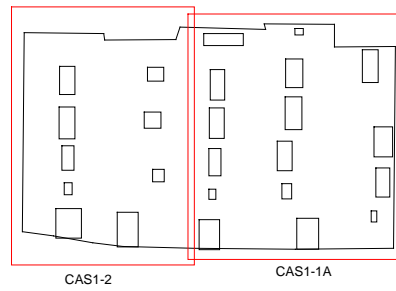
Posición de los pares de la puerta Sur-Oeste de la Muralla
